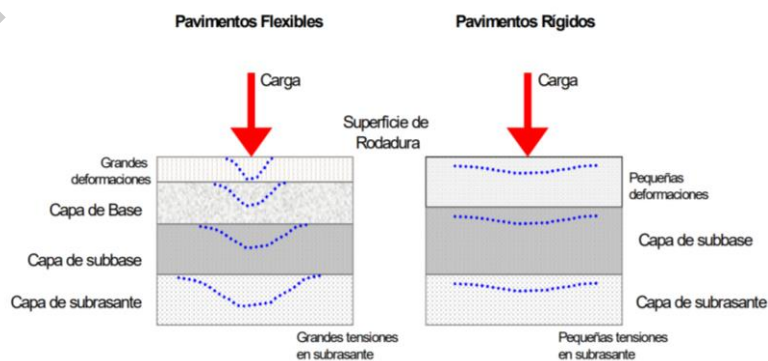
Comportamiento de pavimento flexibles y rígidos.
